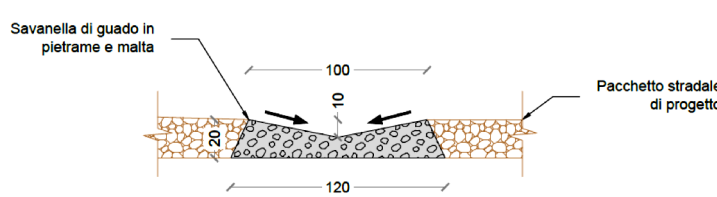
Sezione "Tipo" canaletta di drenaggio realizzata in scavo
